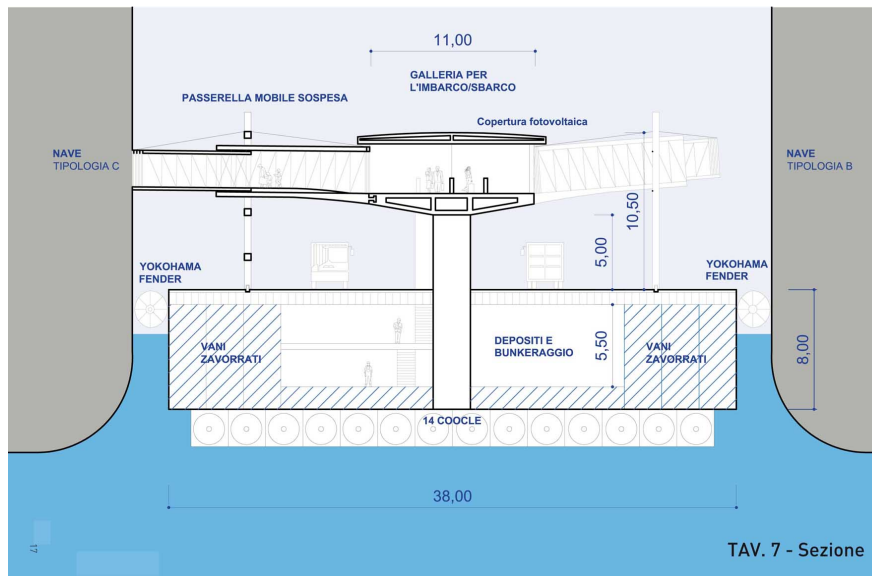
Sezione schematica del pontile di attracco galleggiante ancorato al fondo.
